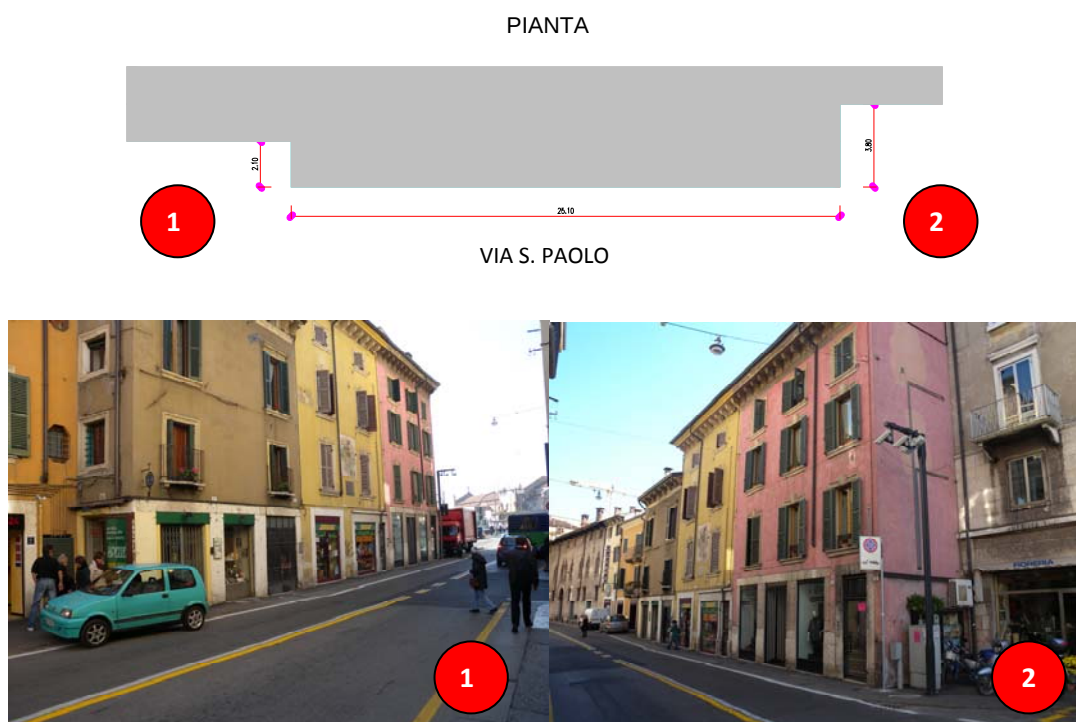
Pianta e foto dell'appendice dell'edificio su Via S. Paolo
